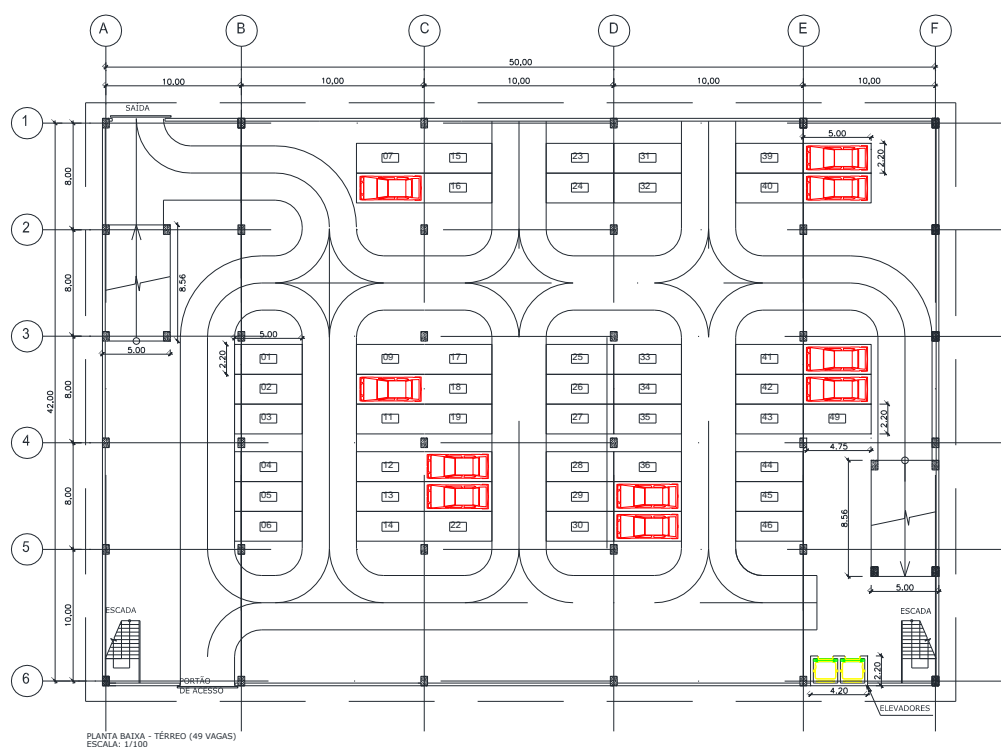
Arquitetura – Planta Baixa do Térreo – 49 vagas
